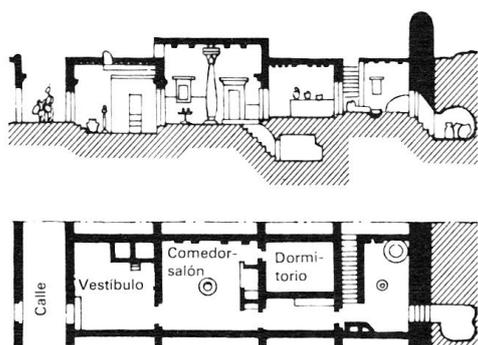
7. Diseño en planta y sección de una casa típica del pueblo Deir el-Medina
